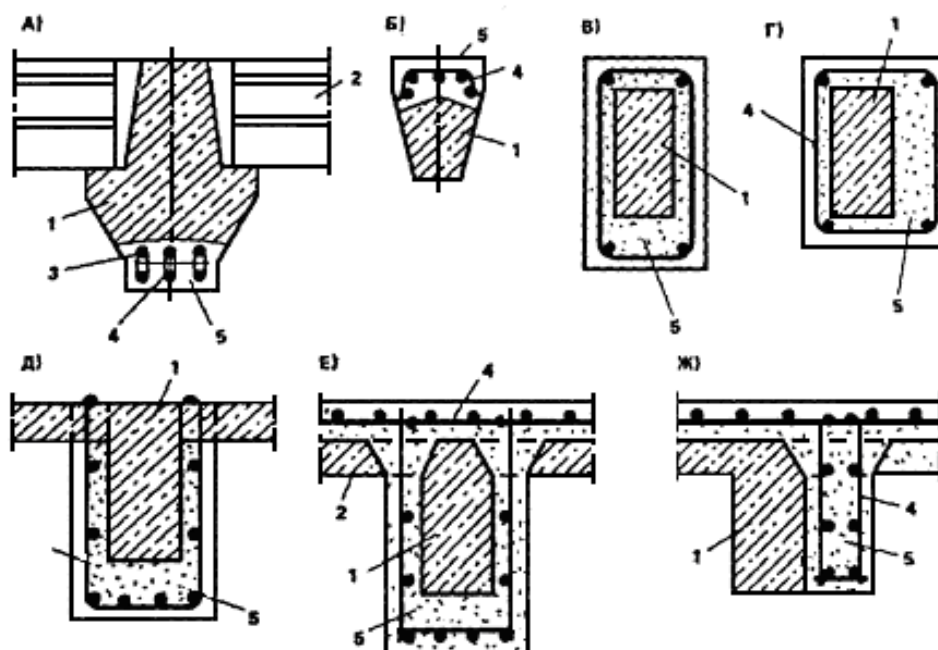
Схемы сечений балок, усиленных железобетоном
